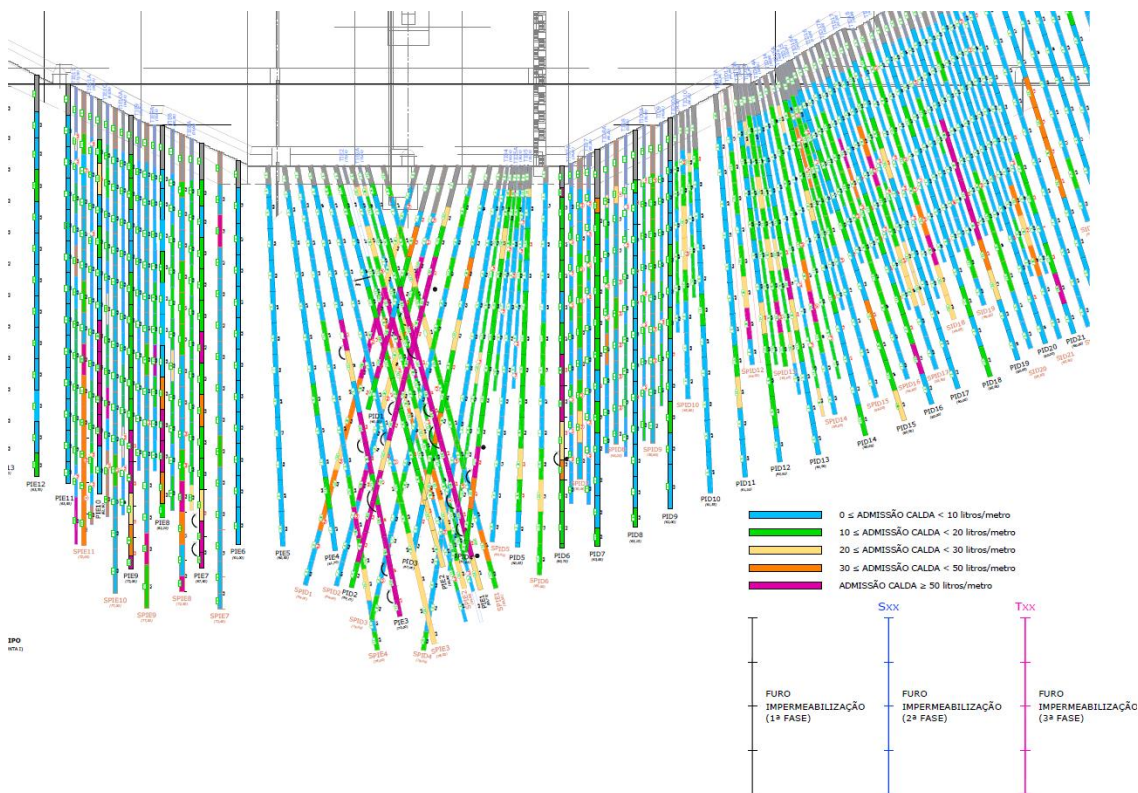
Injeções da cortina de impermeabilização no fundo do vale (vista de montante para jusante)
